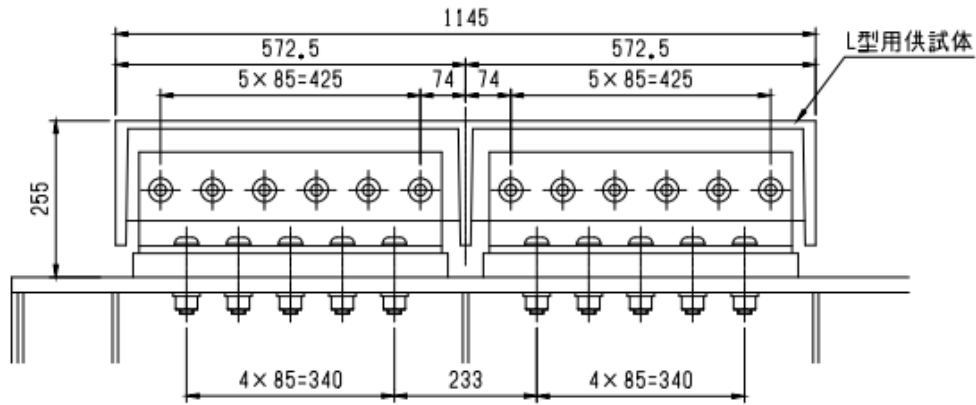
ケース 3 の試験体設置後 側面図(単位 : mm)
